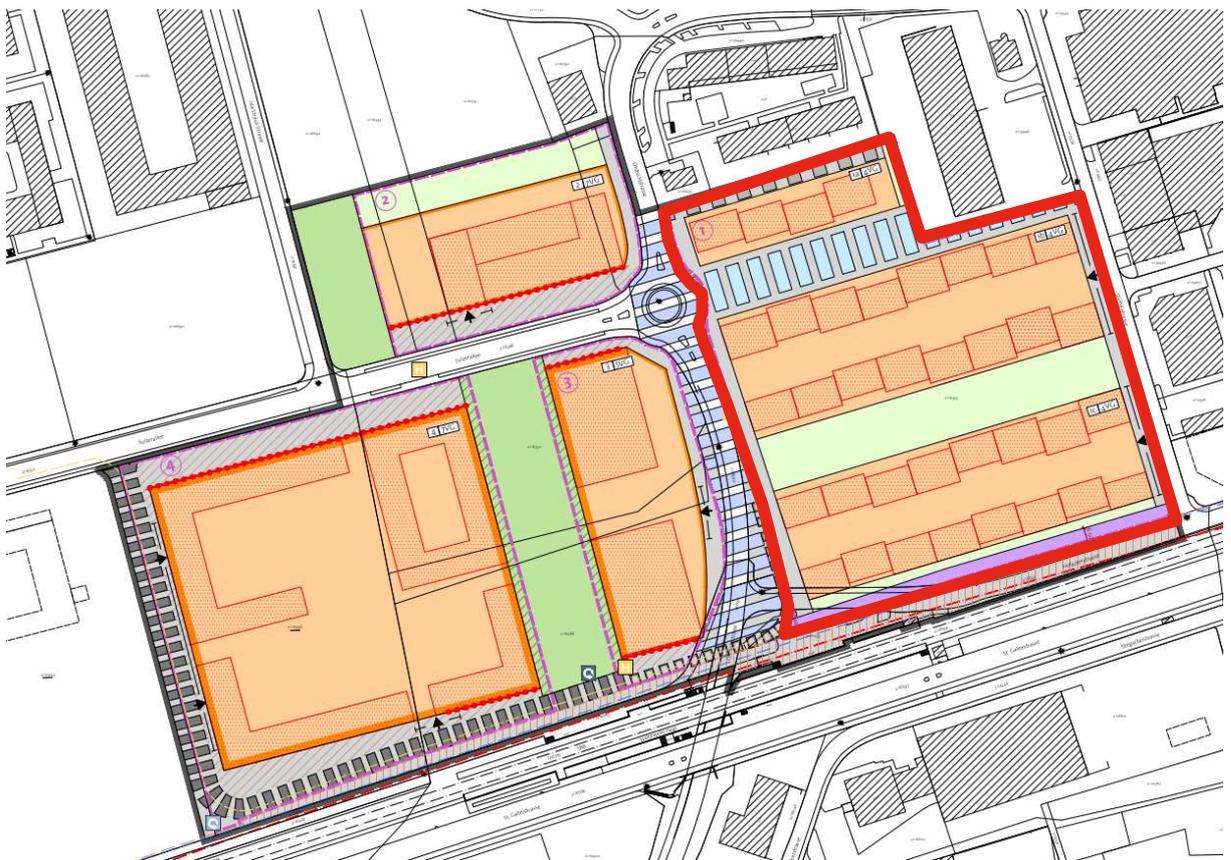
Ausschnitt öffentlicher Gestaltungsplan Umfeld Hegi mit Baufeld 1 (rot markiert)
